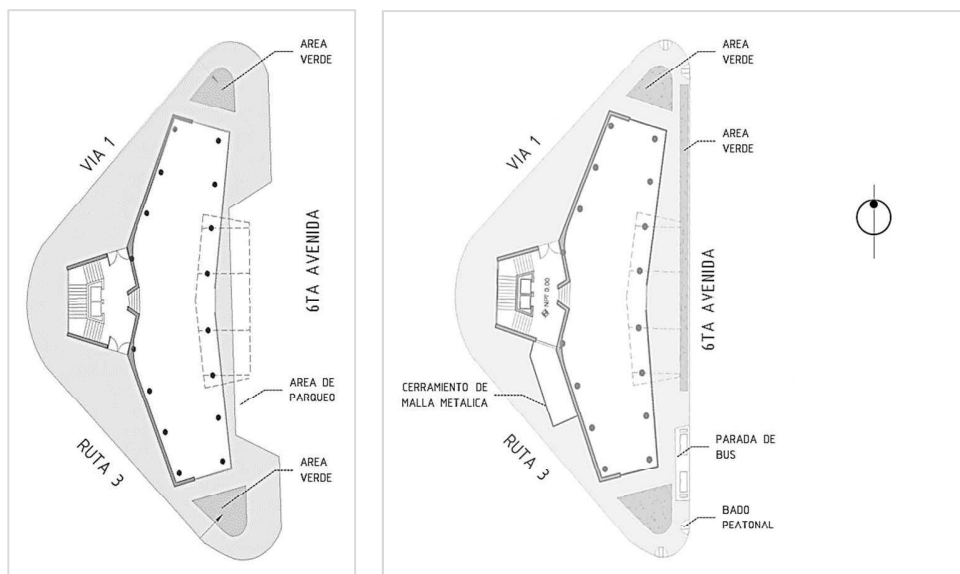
Edificio Italia, Planta baja al inaugurarse y planta baja actual, respectivamente.
